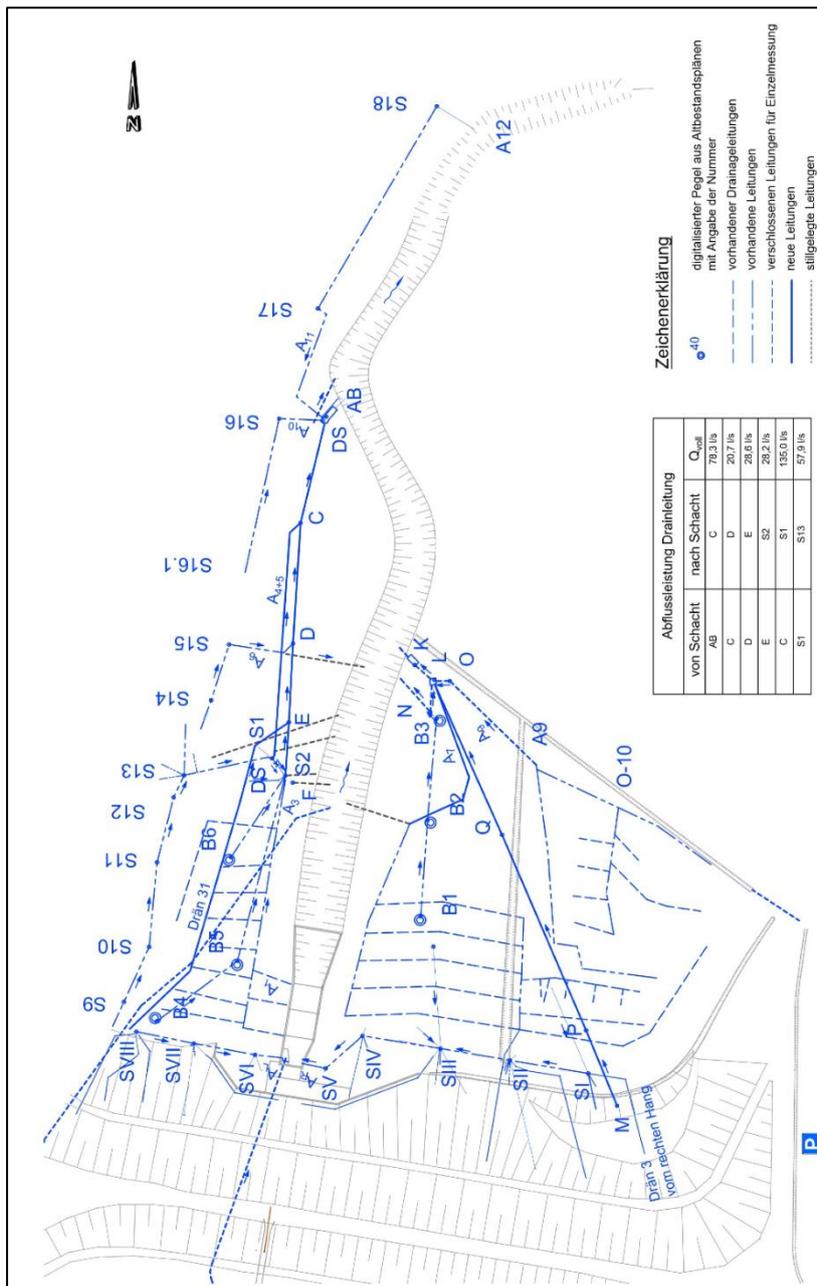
Schematische Darstellung des Drainsystems im Dammbereich
